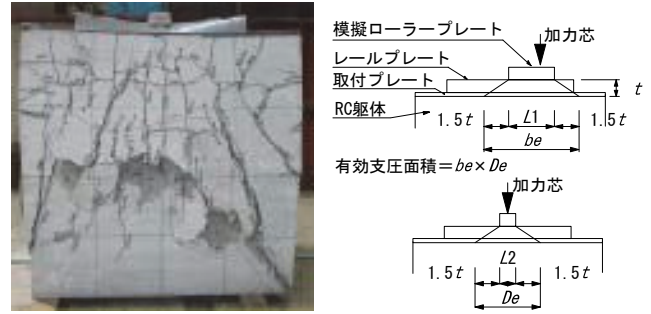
試験後の状況 (No. 2) 図-11 支圧面積の考え方
